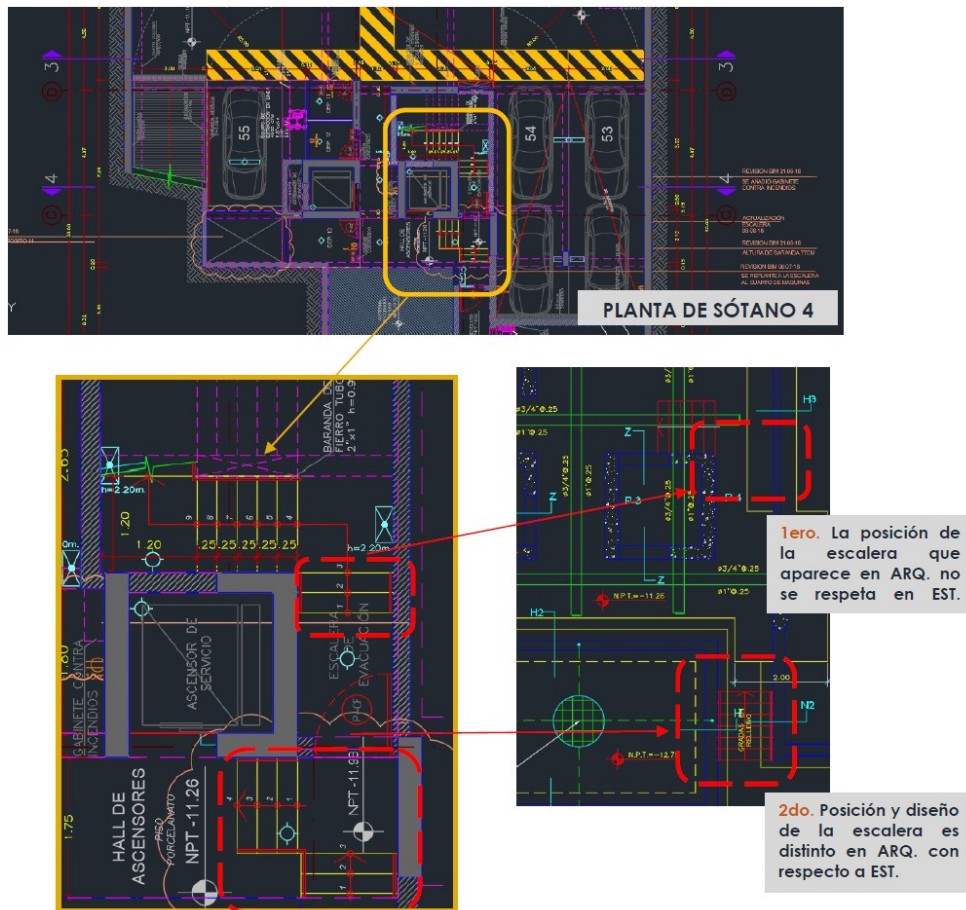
Detalle de incompatibilidad entre el plano de cimentación y arquitecturas del sótano.
